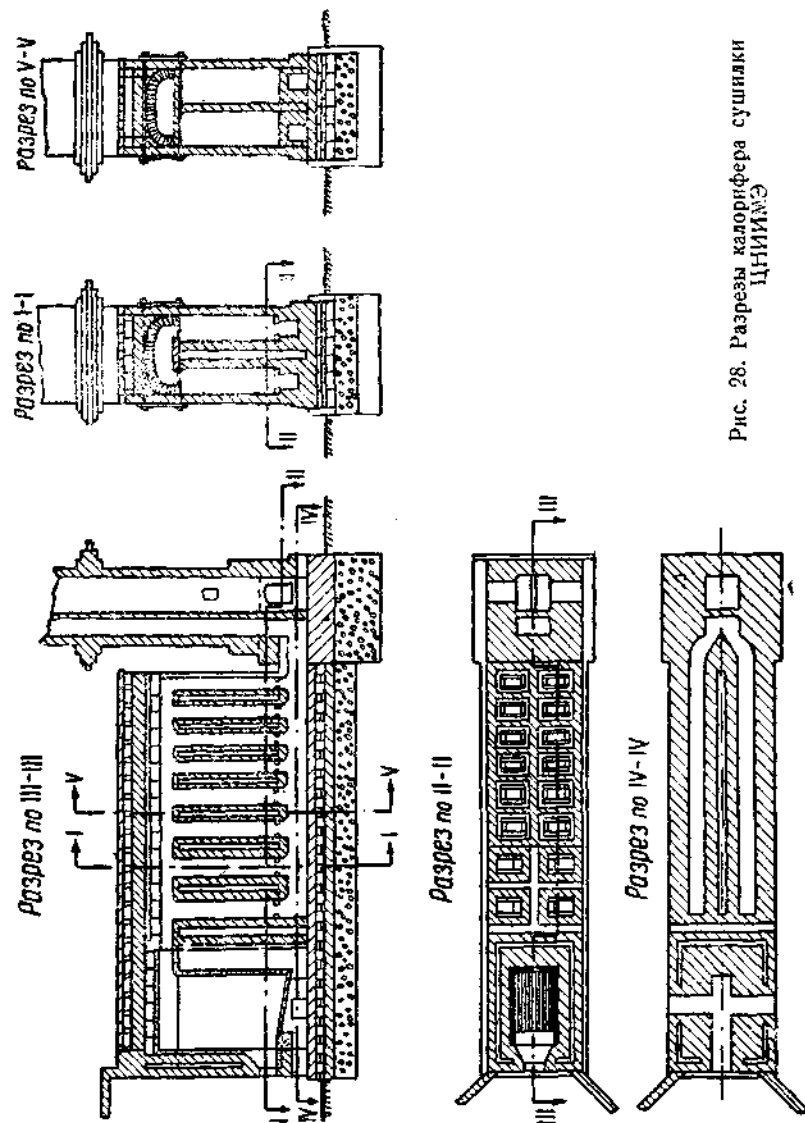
Разрезы калорифера сушилки ЦНИИМЭ
